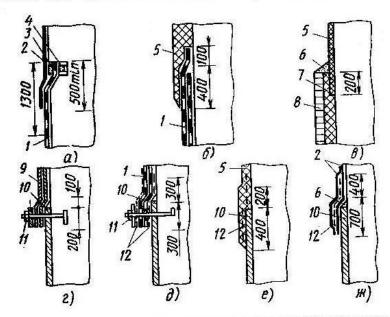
Сопряжения гидроизоляции на вертикальных поверхностях (a-m):
